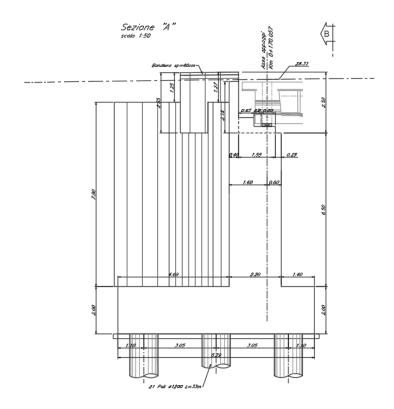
Spalla A - Prospetto longitudinale
